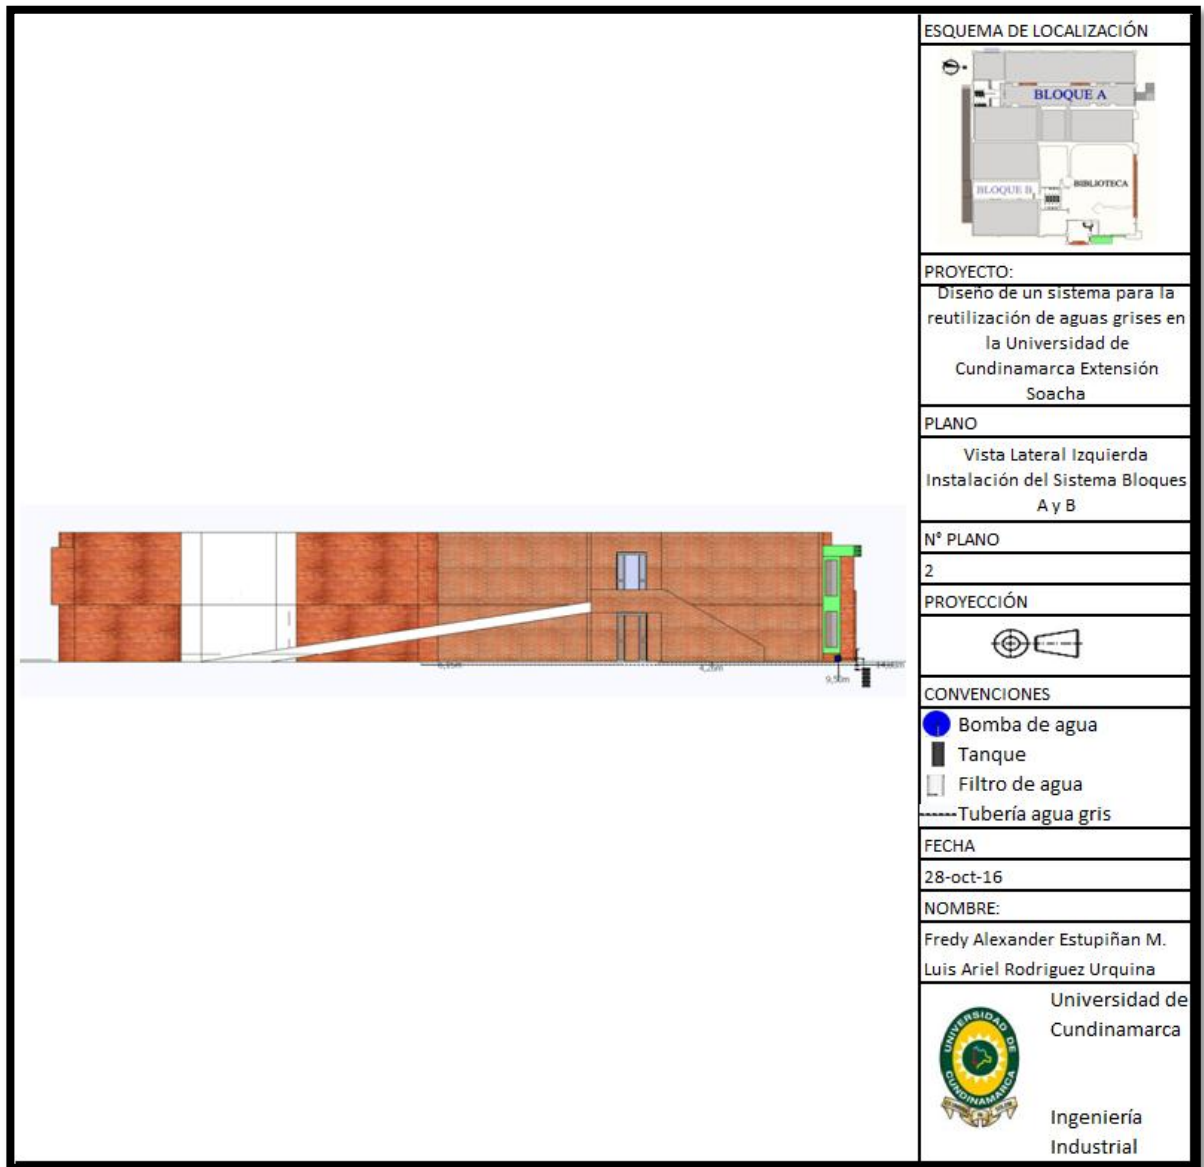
Vista Lateral Izquierda Instalación del Sistema Bloques A y B
